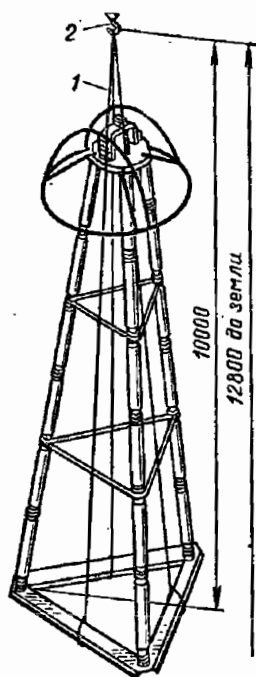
Строповка шинной опоры ШО-750 в сборе:
